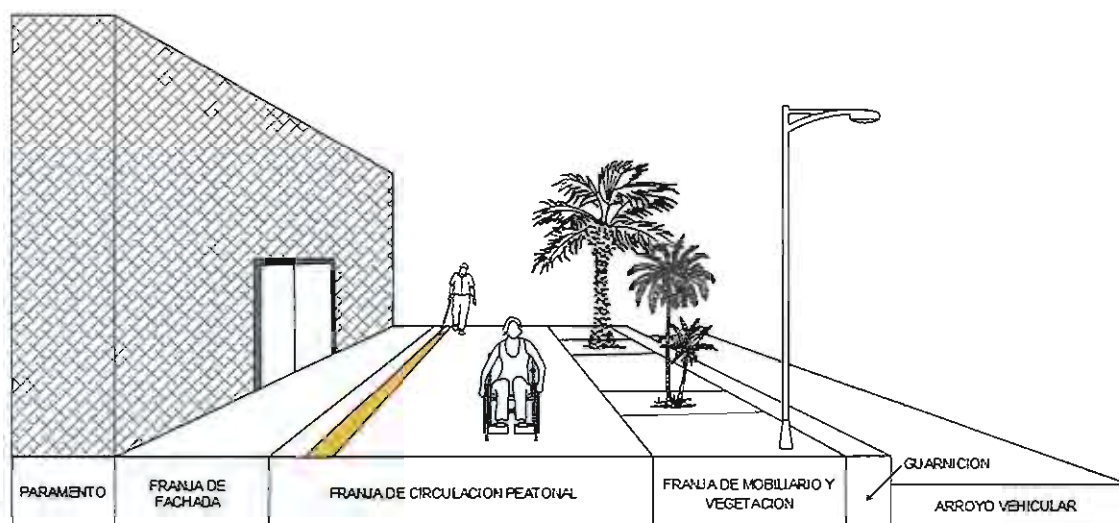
Detalle de circulación en banqueta (planta arquitectónica)
